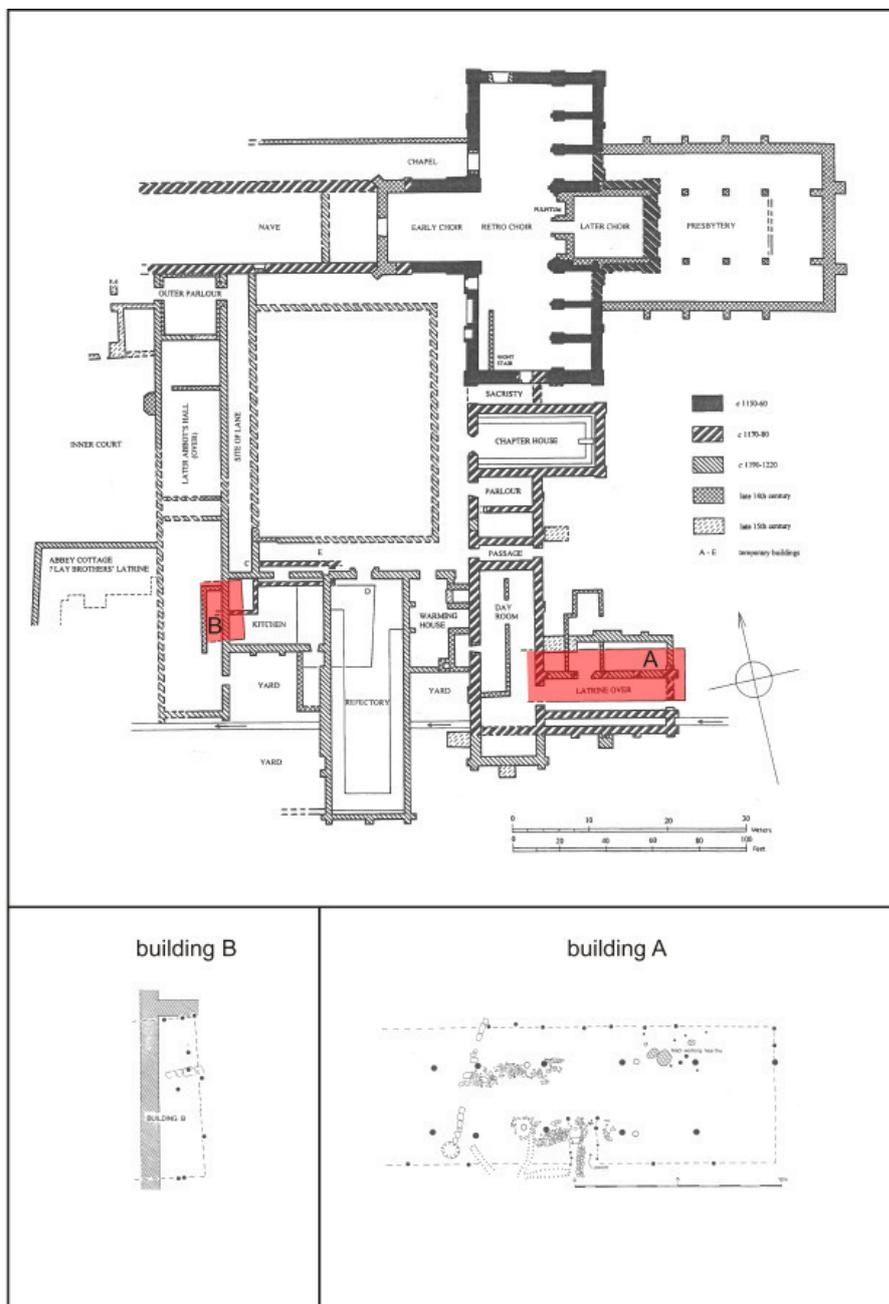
Sawley Abbey. Oben : Bauphasenplan, die ältesten Bauten sind rot eingefärbt. Unten rechts: Detailplan Gebäude A. Unten links: Detailplan Gebäude B.
